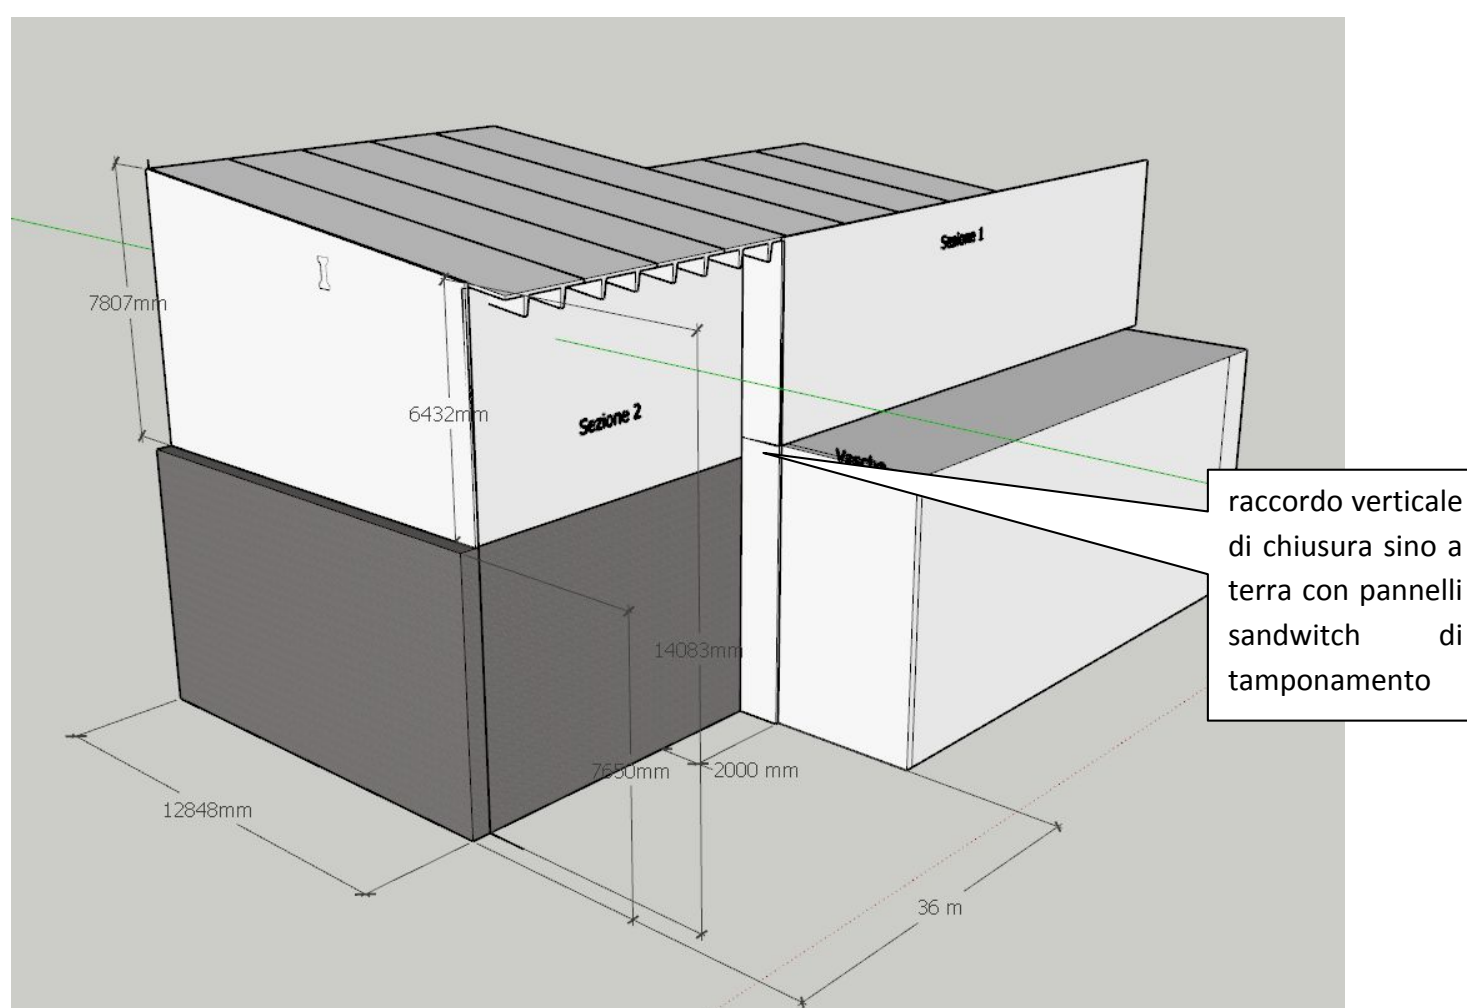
Zona di chiusura tettoia tra sezione 1 e sezione 2
